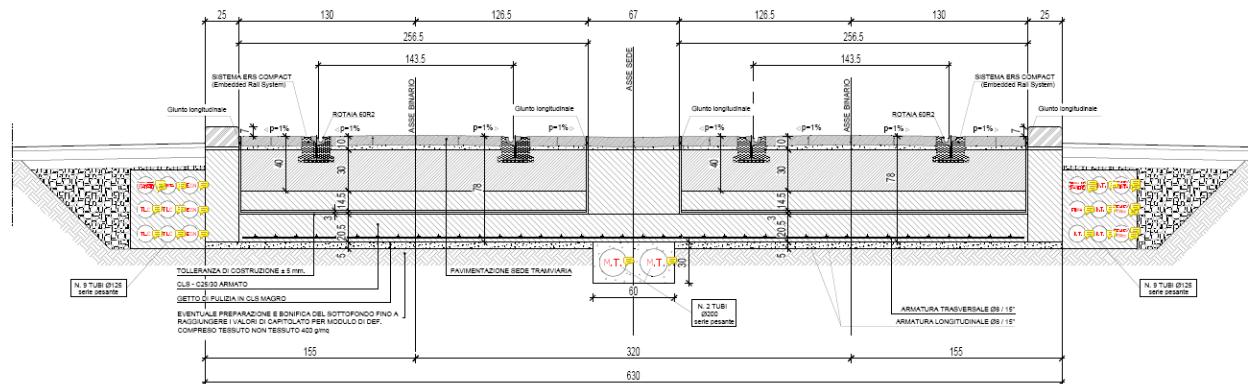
Sezione trasversale dell'armamento estratta dalla Relazione Generale del Progetto Esecutivo
